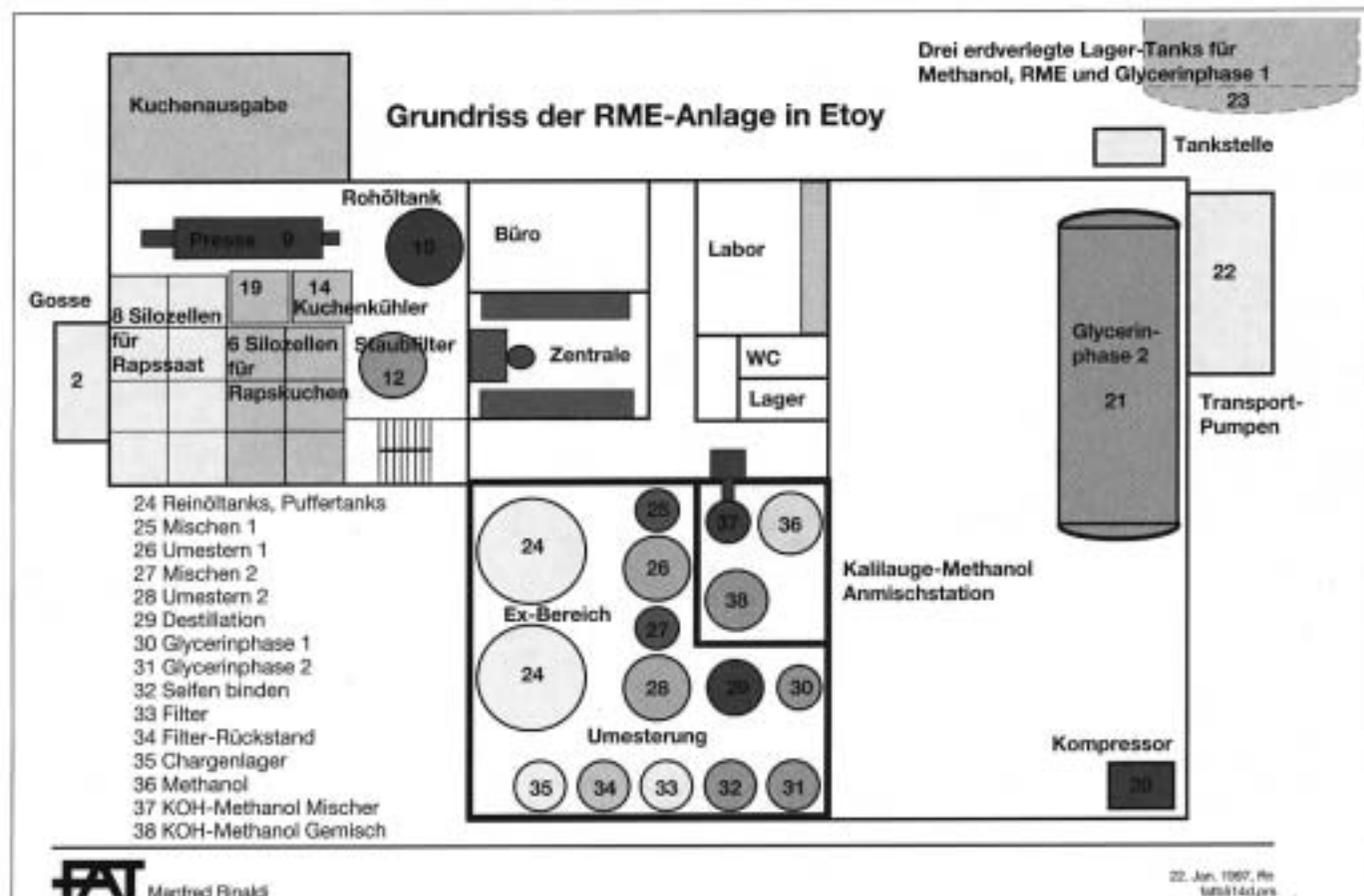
Grundriss der RME-Anlage in Etoy.
